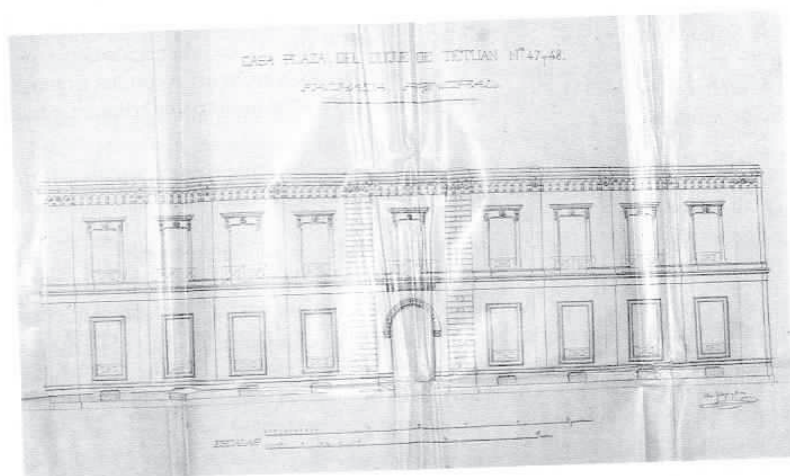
Proyecto de fachada en plaza Duque de Tetuán 47 y 48. Elías Gallegos, 1873.
